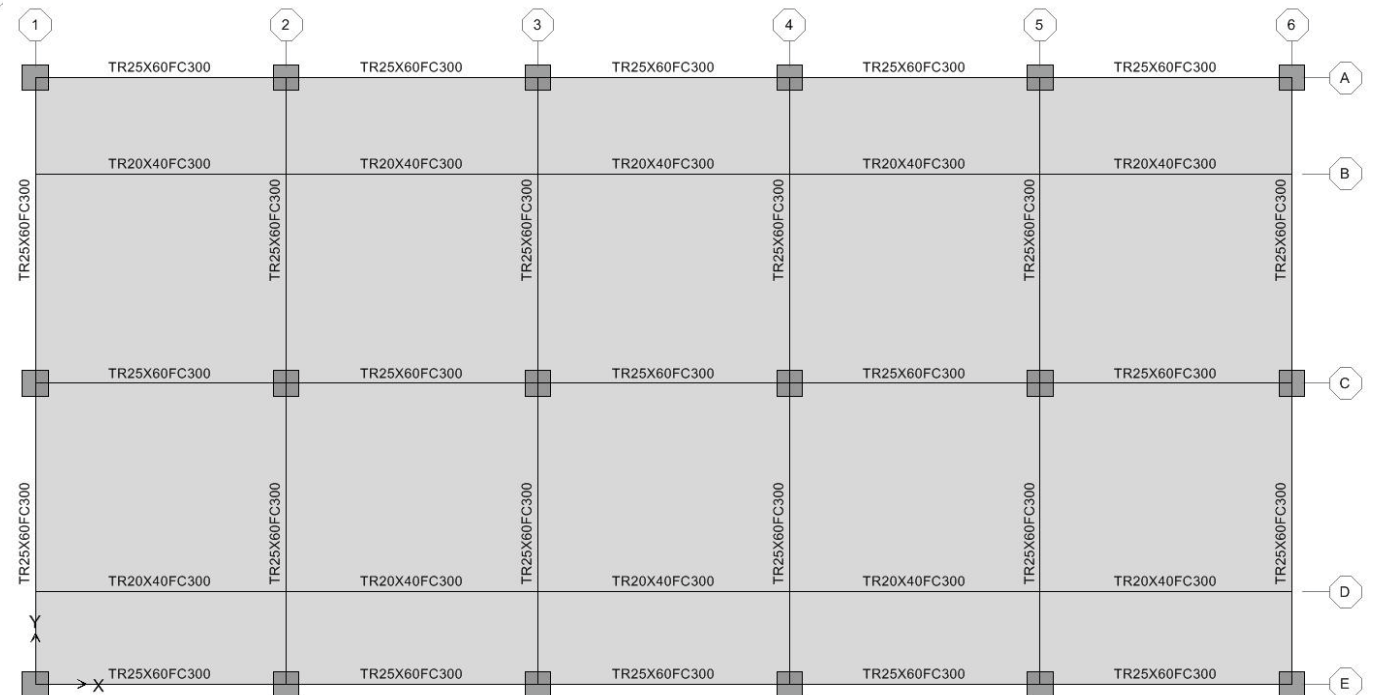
Elevación Marco Transversal-Planta Tipo Bloque 5 Habitaciones Modulo Recto.
